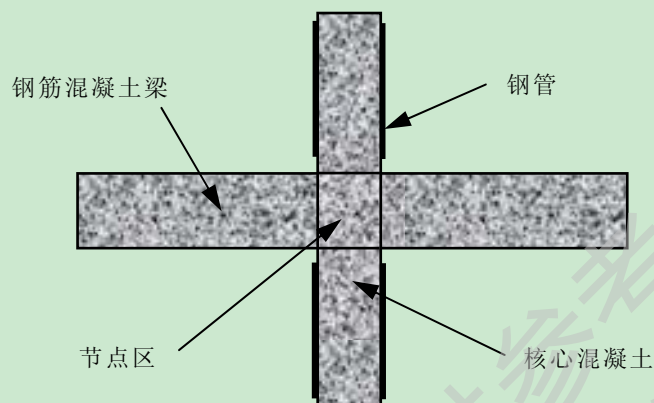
钢管约束混凝土柱-钢筋混凝土梁节点
